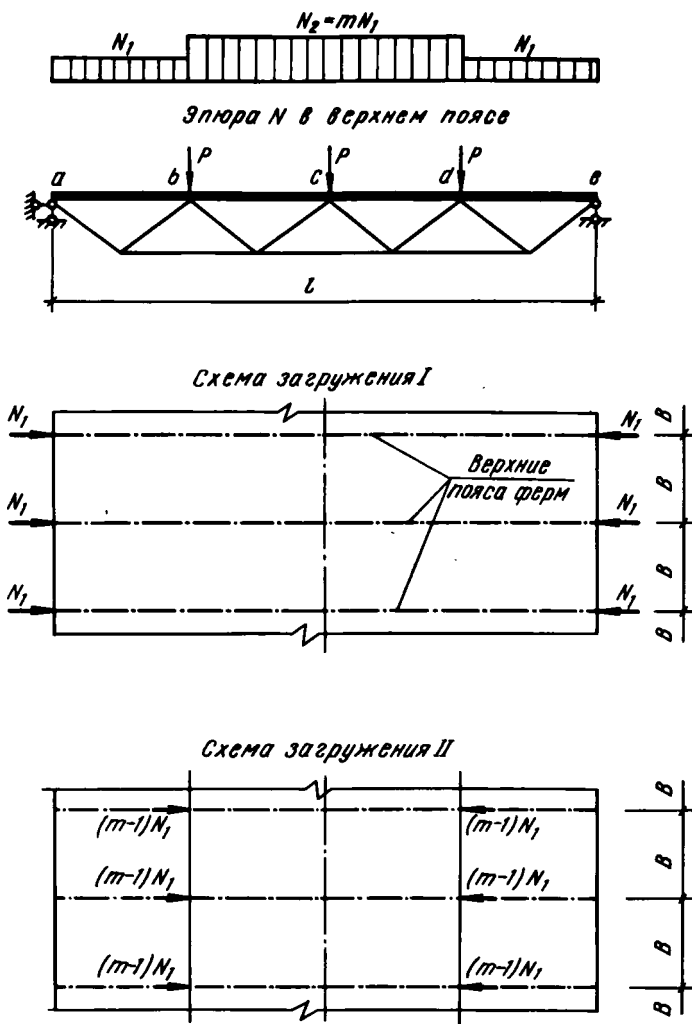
Схемы загрузкиения настила сталежелезобетонных ферм покрытия при определении его напряженного состояния.
